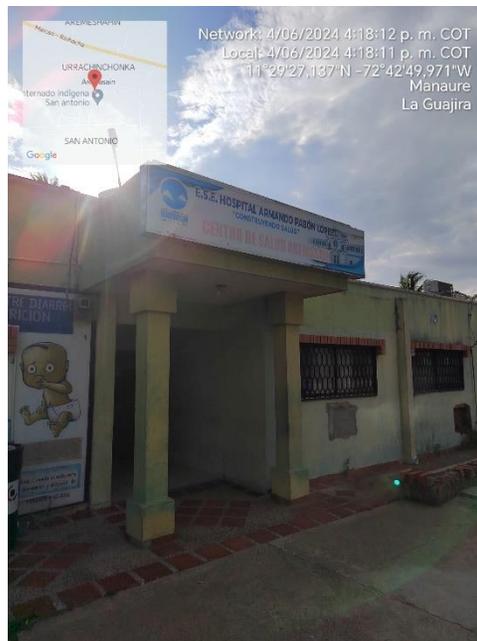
Fachada frontal del Centro de Salud Aremasain
